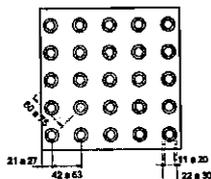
Sinalização tátil de alerta — Modulação do piso
